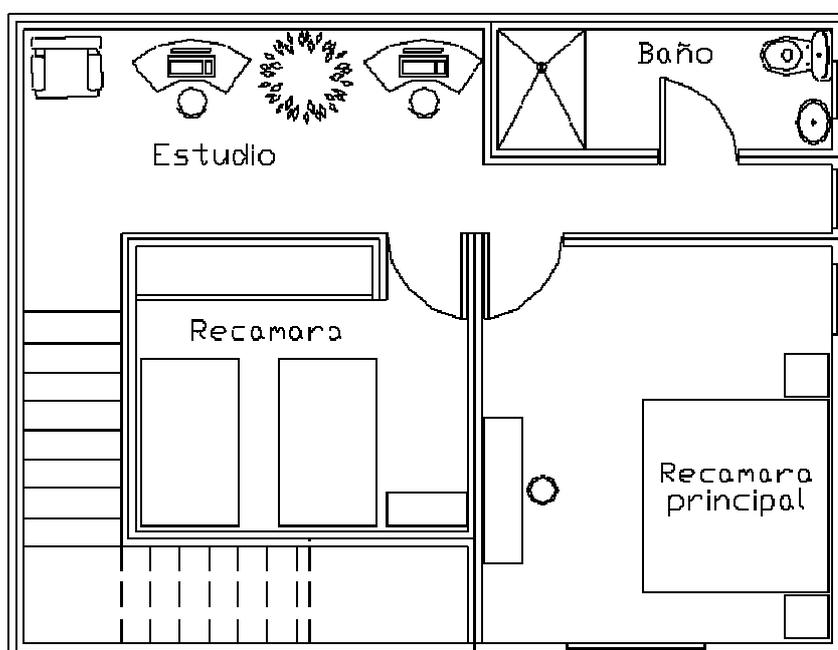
Plano arquitectónico del primer piso de la casa habitación.
